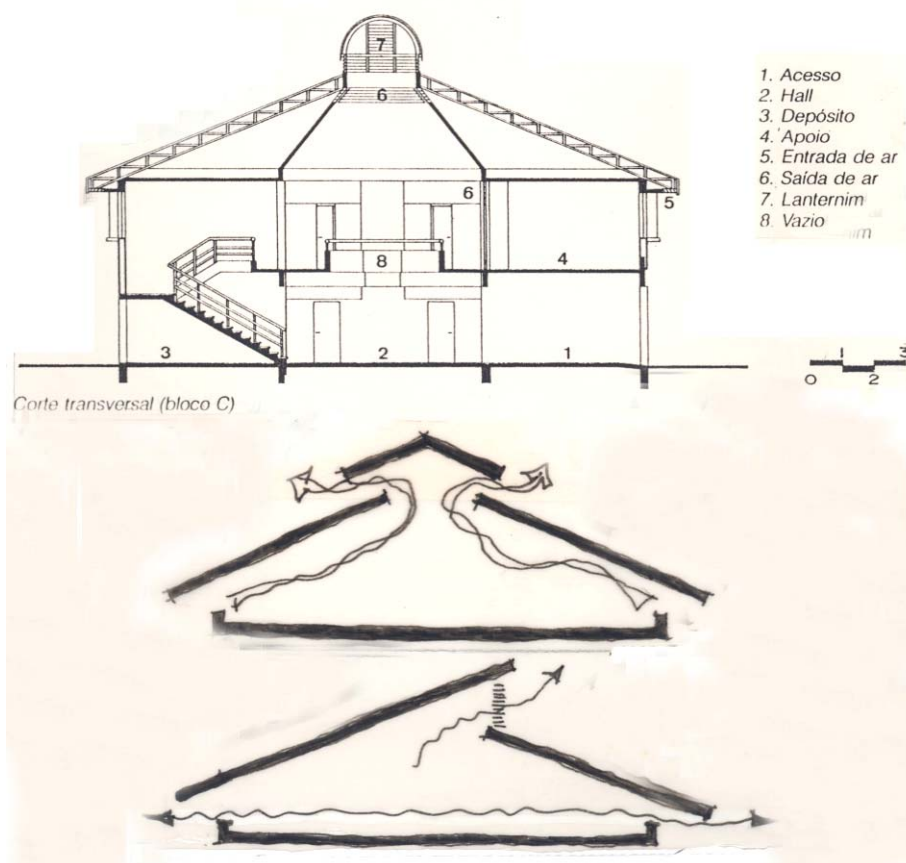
Acima, Escola Jean Piaget (Porto Alegre);
